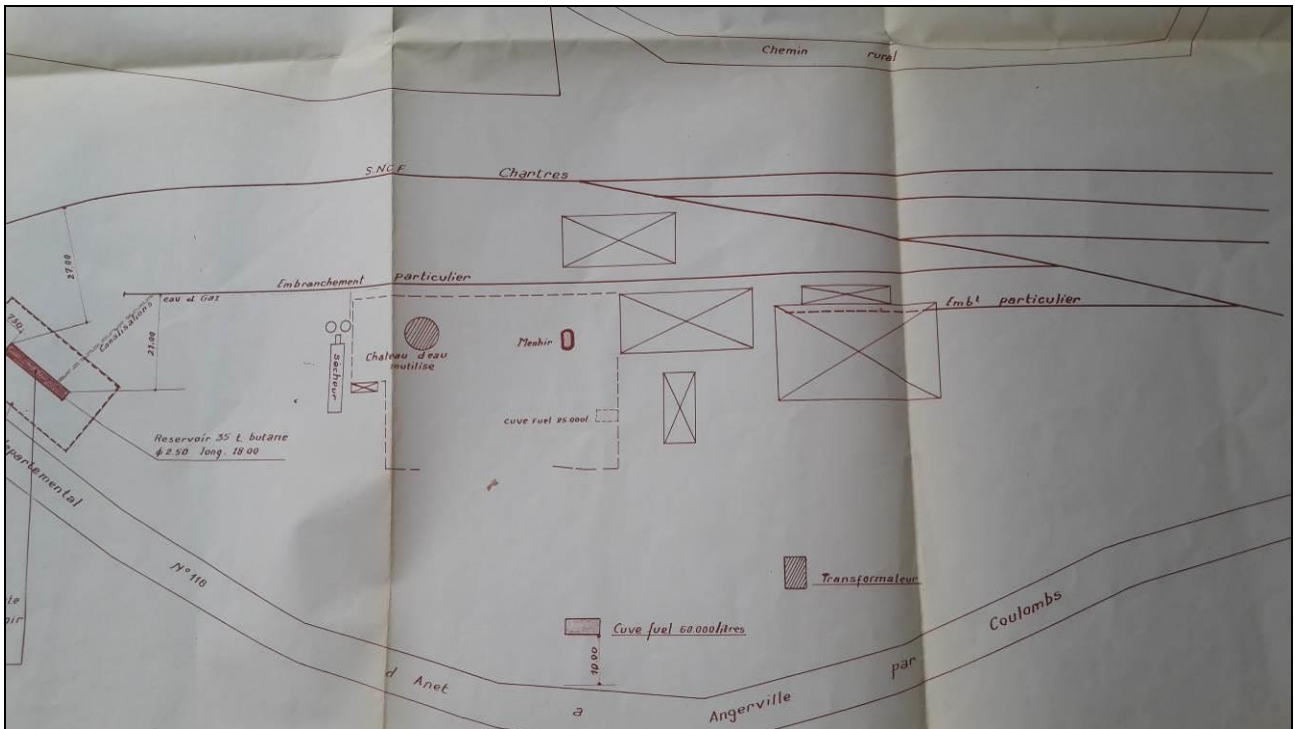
Plan des installations de la SABLEM (source : Préfecture 28 – Août 2017)
